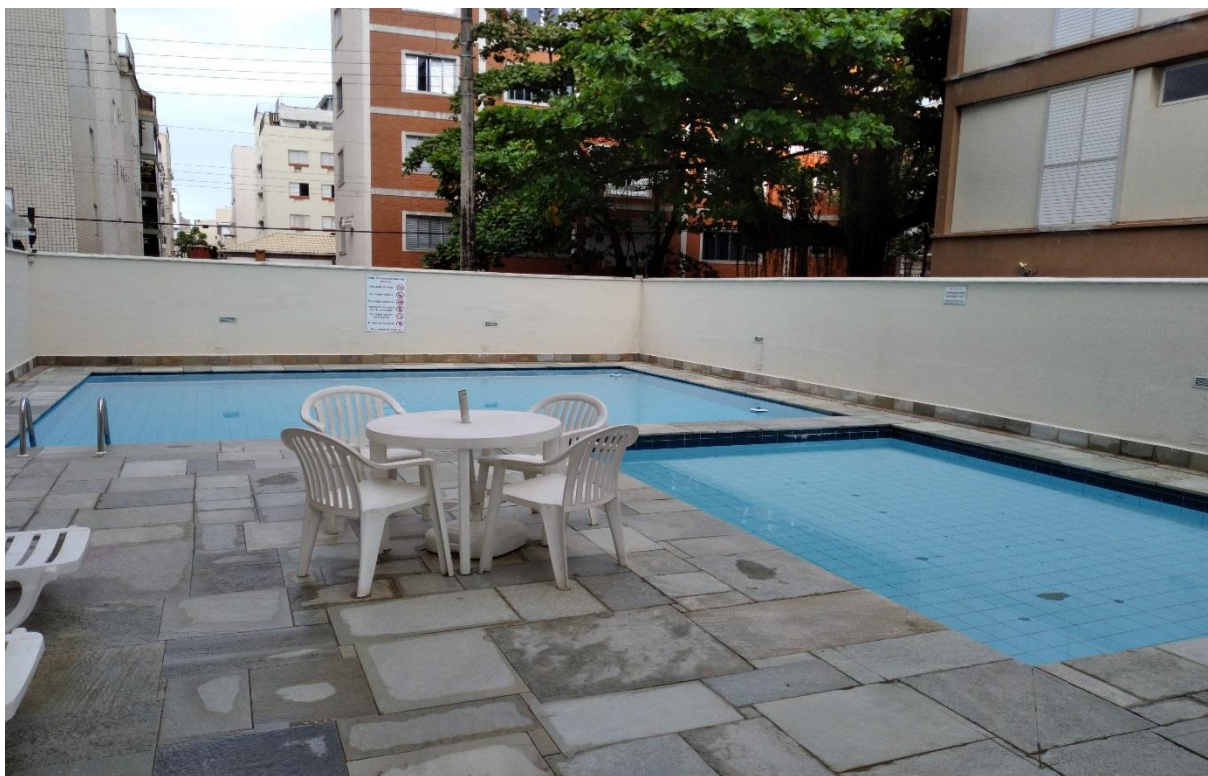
Vista parcial da área externa do edifício (pavimento térreo) e a piscina de uso comum.
